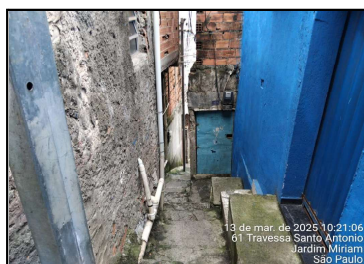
TRAVESSA SÃO JOAQUIM
